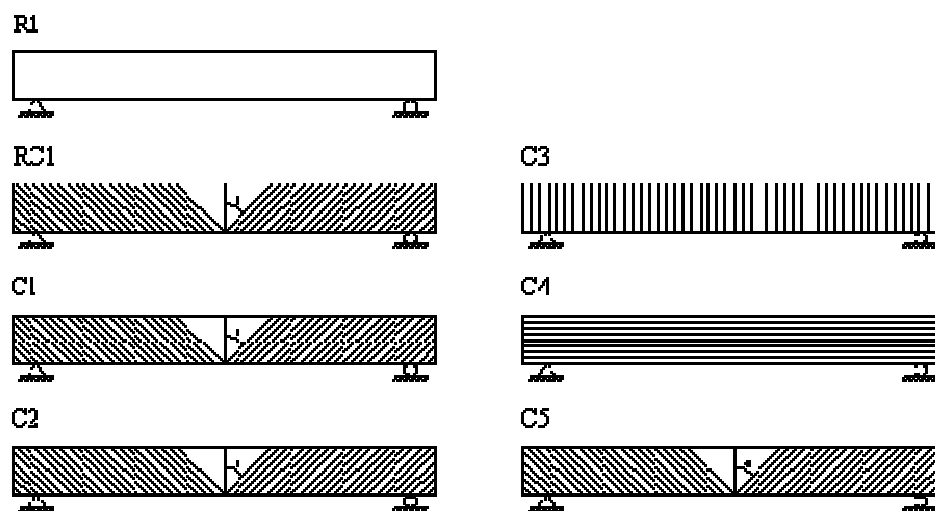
Detalhes dos reforços externos das vigas ensaiadas (TÄLJESTEN *et al.*, 2003).
